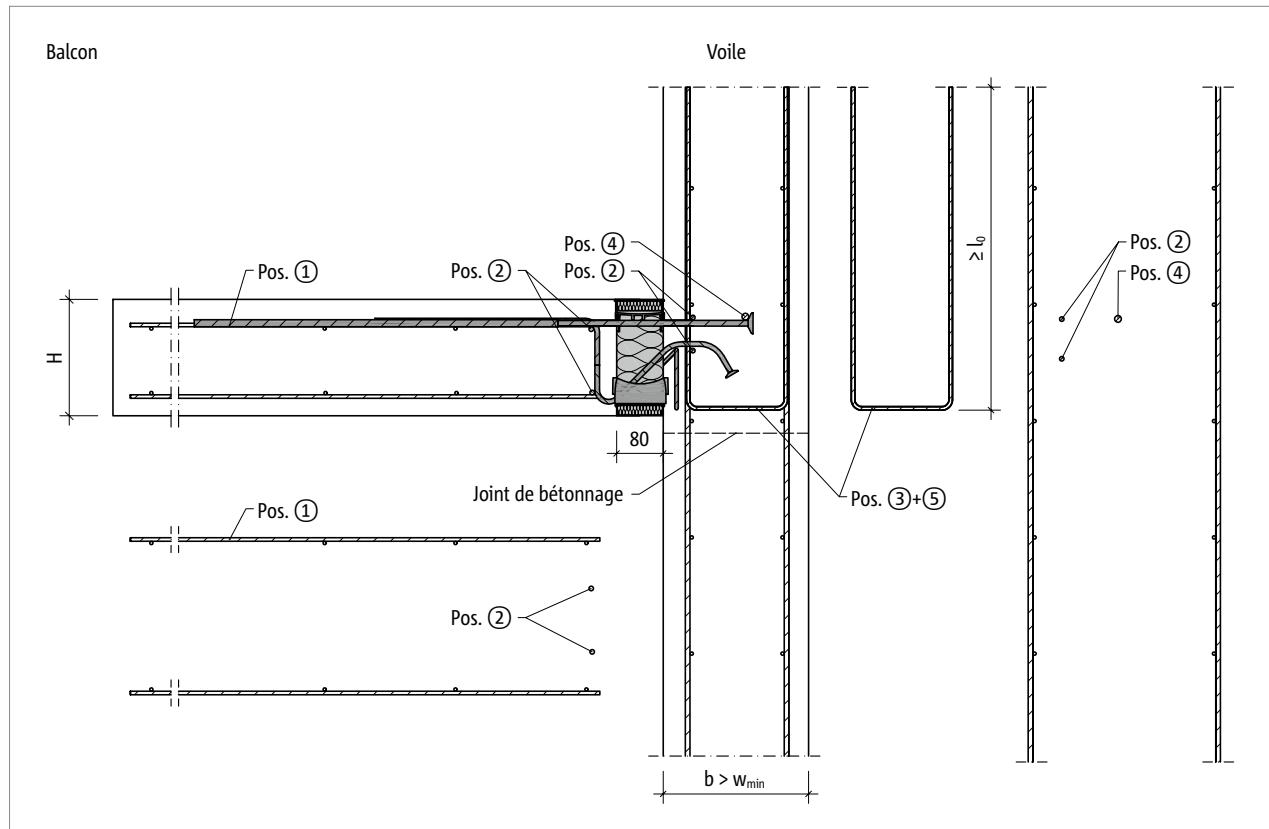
Schöck Isokorb® T type K-U : Renforcement sur site pour raccordement mural vers le haut avec une dimension plus grande du composant ($w_{prés} > w_{min}$)
